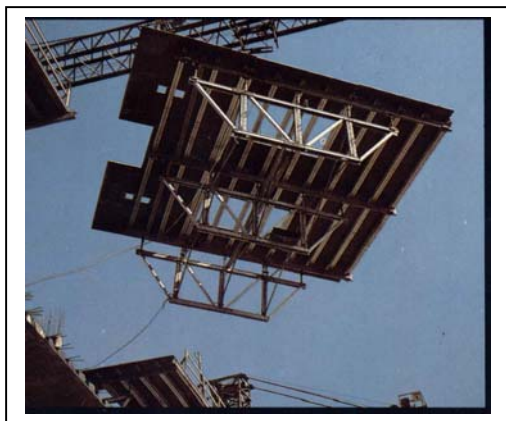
Aspecto da mesa voadora, que consiste no escoramento de uma laje montada em um único bloco, que é montado em um local e posteriormente é levado até o local da concretagem por meio de guindaste. Após a concretagem de um pavimento, o equipamento é levado ao pavimento subsequente.
